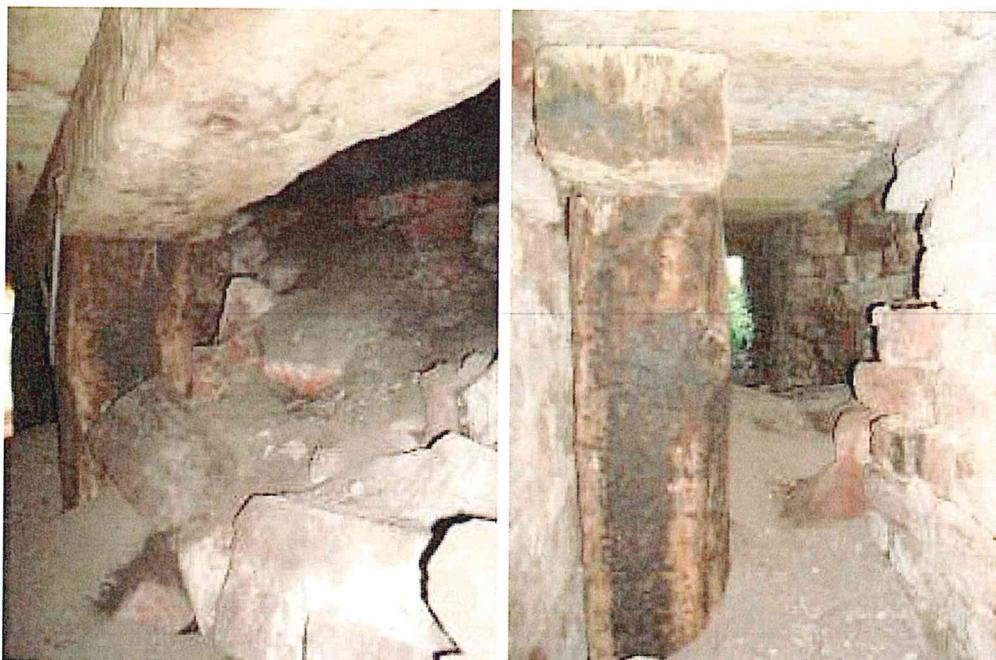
și FOTO 5. Sprijinire zonă prăbușită
